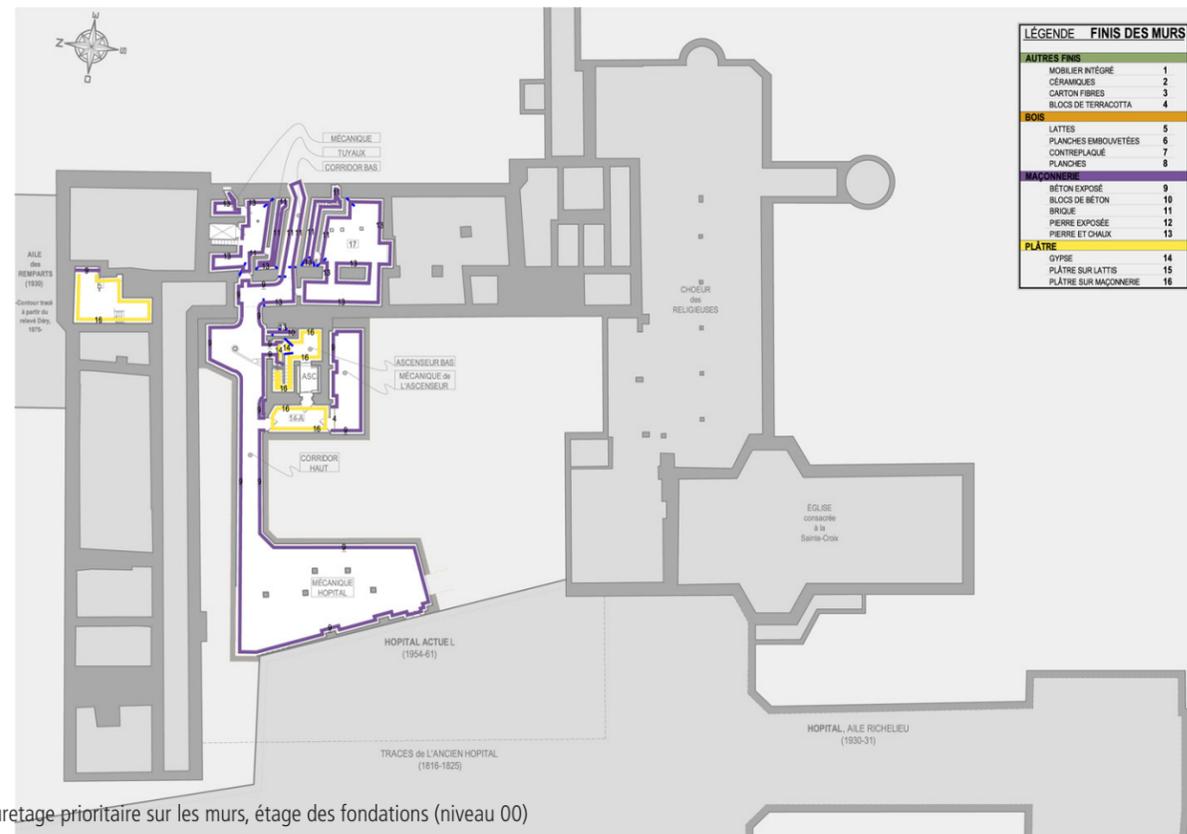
Plan de curetage prioritaire sur les murs, étage des fondations (niveau 00)
